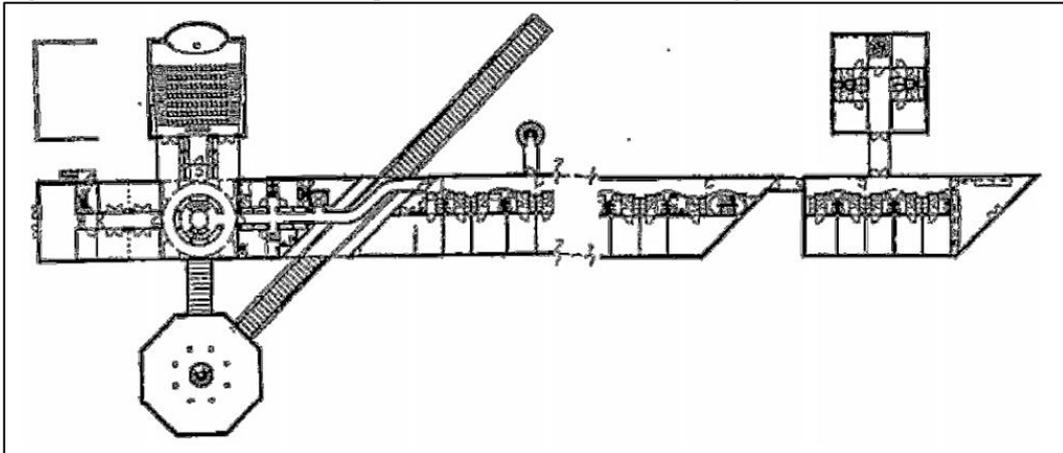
Planta do Pavimento Térreo do Moller Centre em Cambridge, Reino Unido
